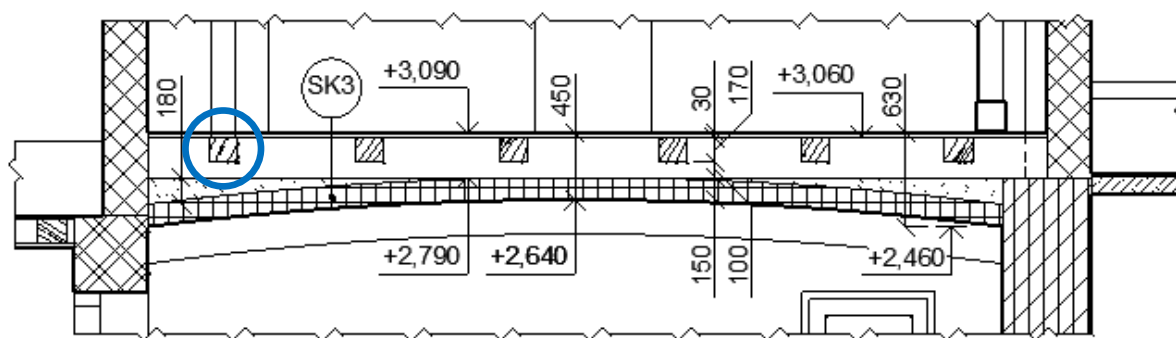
půdorys rozmístění stojin pod líc klenby,
